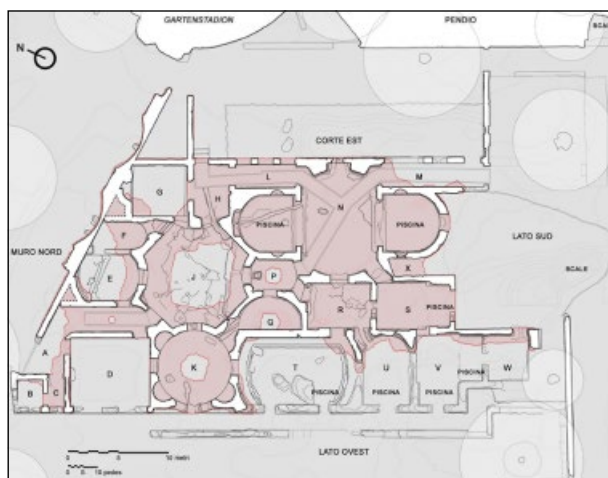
Planimetria delle Piccole Terme da rilievo laser scanner terrestre (2015): con retino rosso la proiezione delle volte esistenti (elaborazione: G. Bertacchi).
